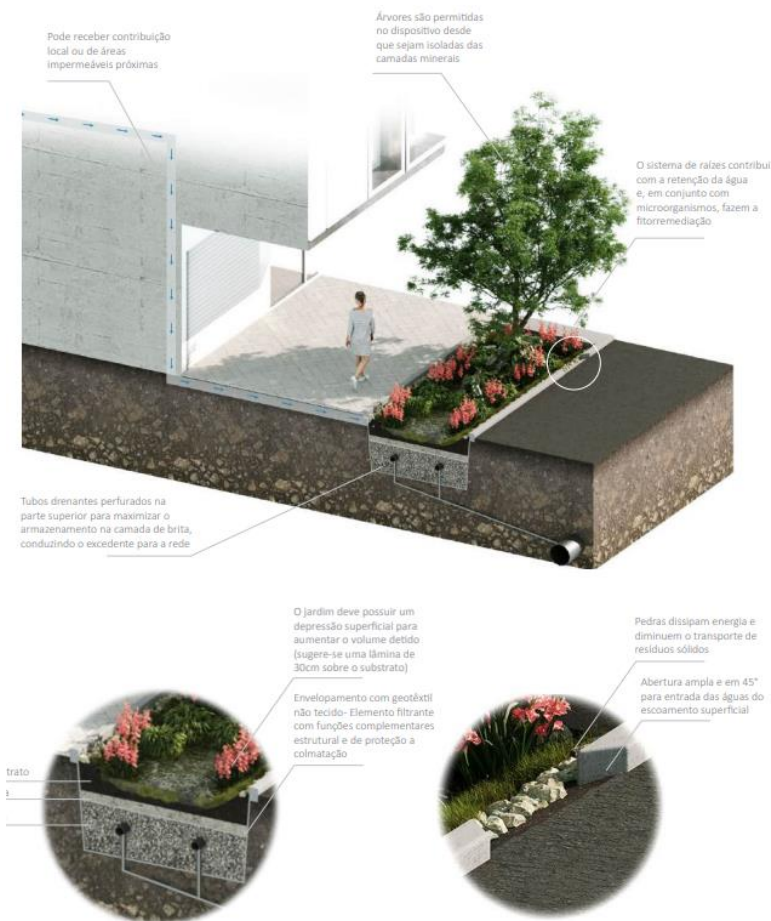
Canteiro Pluvial (Fonte: Guajava, 2023)
